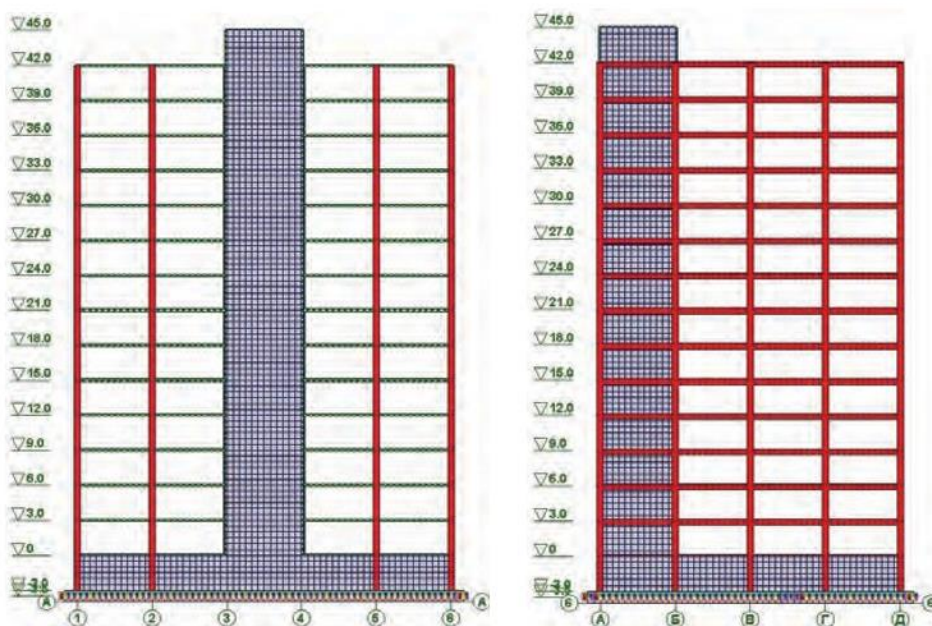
Расчетная схема монолитно-каркасного 14-этажного дома с подвальным этажом на плитном фундаменте
